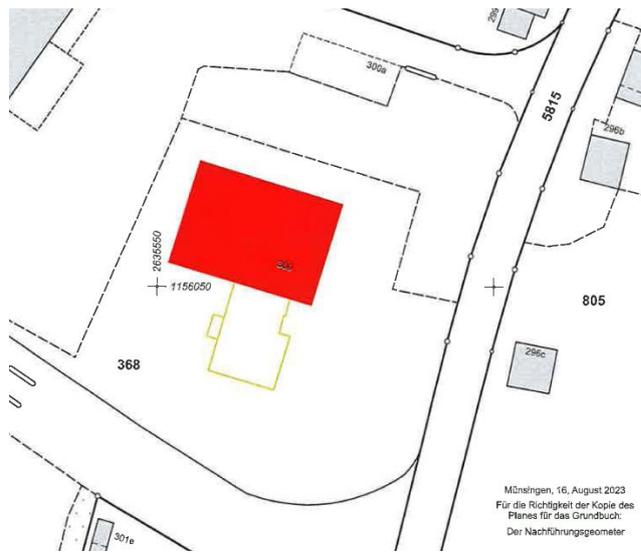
Planausschnitt Vorprojekt, planart Grindelwald, 17.08.2023. Gelb: bestehendes Haus, Rot: Neubau.
